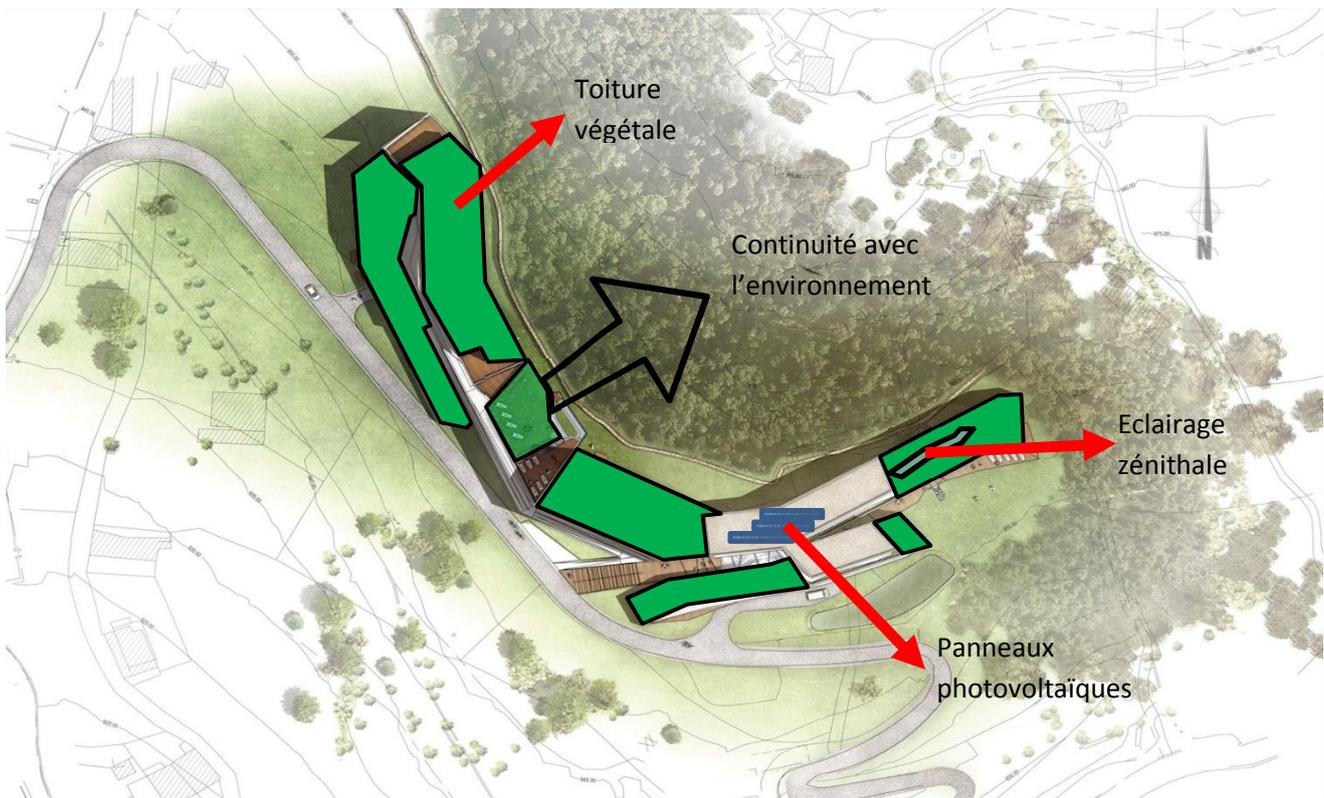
Vue en plan sur les technique utilisées (Source : Auteur)
